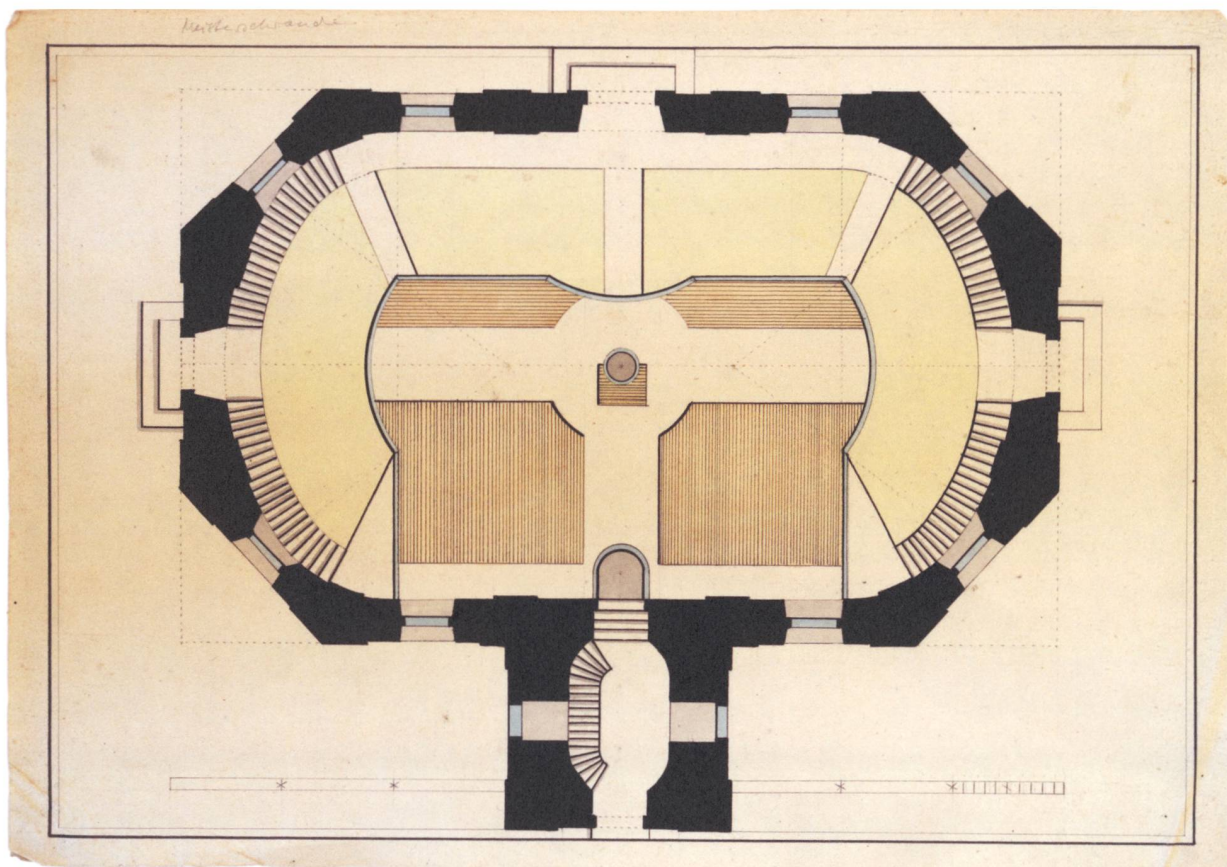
Grundriss einer Querkirche aus dem Nachlass Jost Kopp mit eingezeichneten Kirchenbänken und der hufeisenförmig angelegten Empore (1811 oder 1819. Tinte, laviert. 46 x 31.5 cm). Der Plan ist nachträglich in Bleistift mit «Meisterschwanden» beschriftet. (Nachlass Jost Kopp. Archiv des Schlossmuseums Beromünster. Fotos: Martin Gantner/Jasmin Schäfer, ETH Zürich.)
